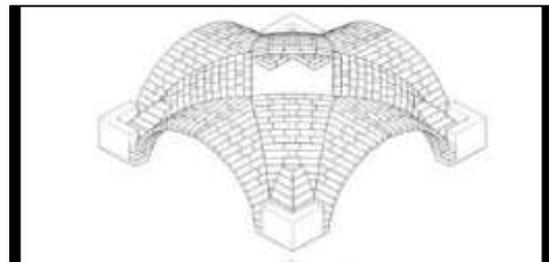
des voutes construit en pierre/ (sources:alliche:2018)
